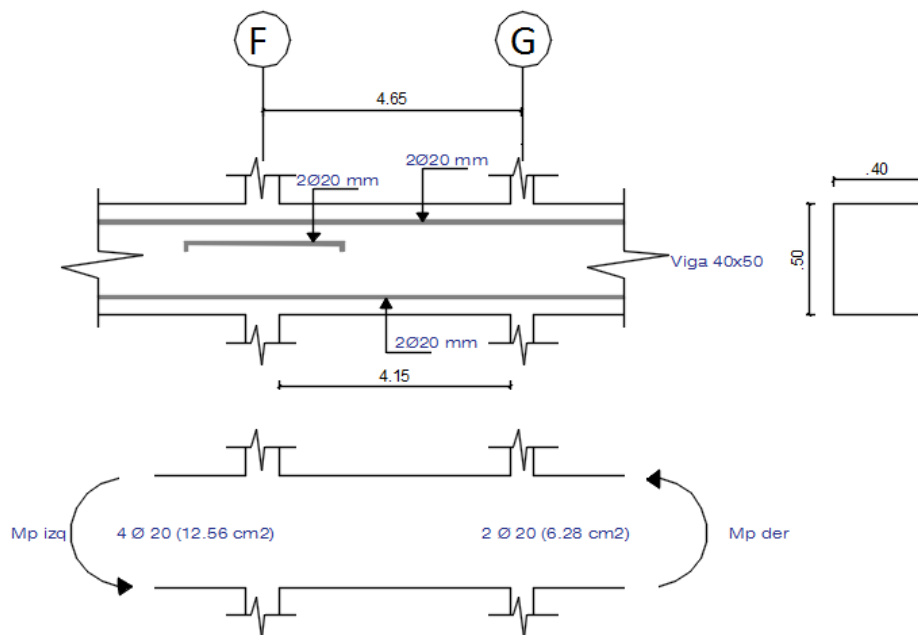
Esquema de armado de viga põrtico 2, N-2.88 m
